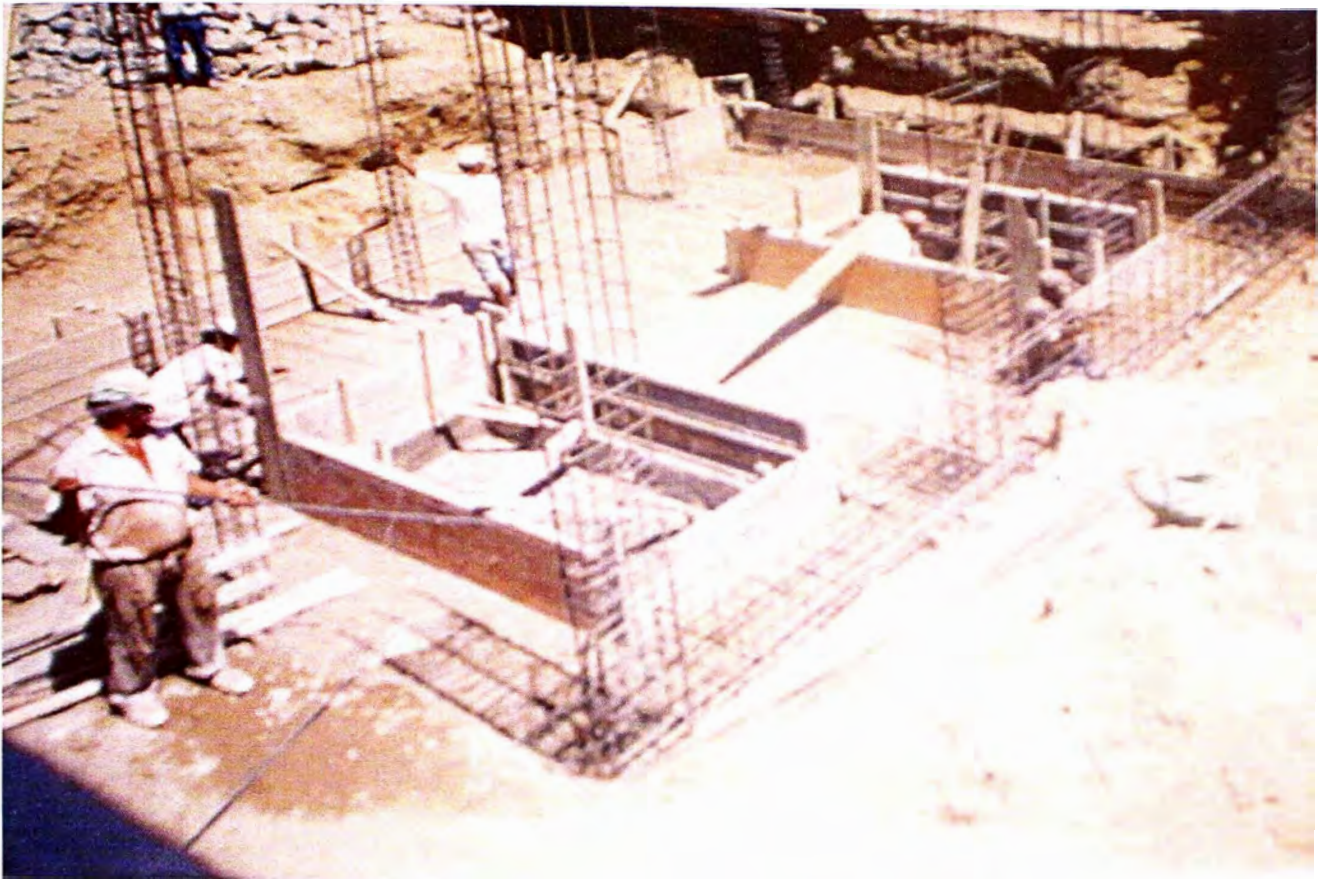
VISTA DE CIMENTACIÓN DE S.S.HH.
